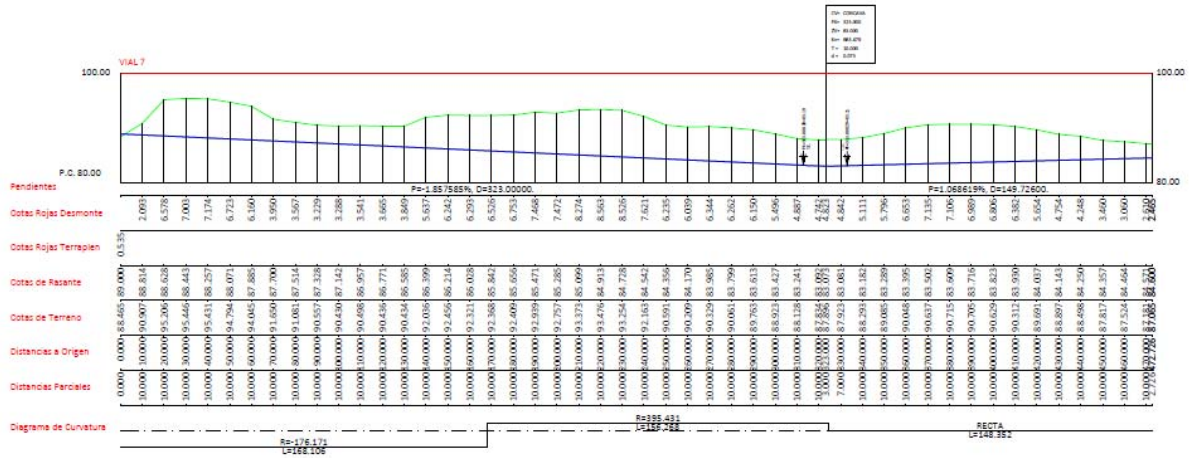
Imagen de la sección longitudinal del vial 7 en la alternativa 2.
